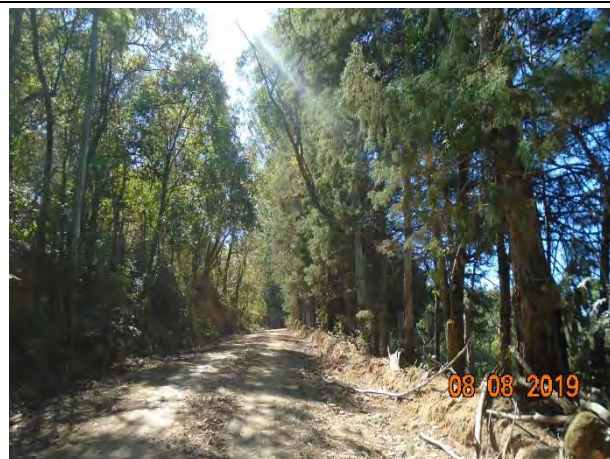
Percuso percorrido – Estrada sem pavimentação.
